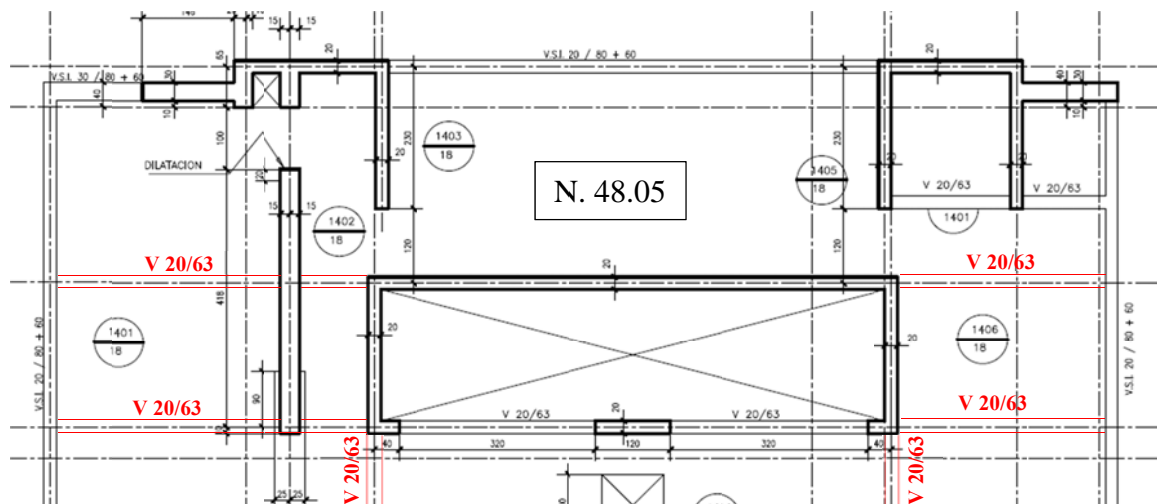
Nueva Estructuración de la Zona Fija de la Losa de Azotea.
